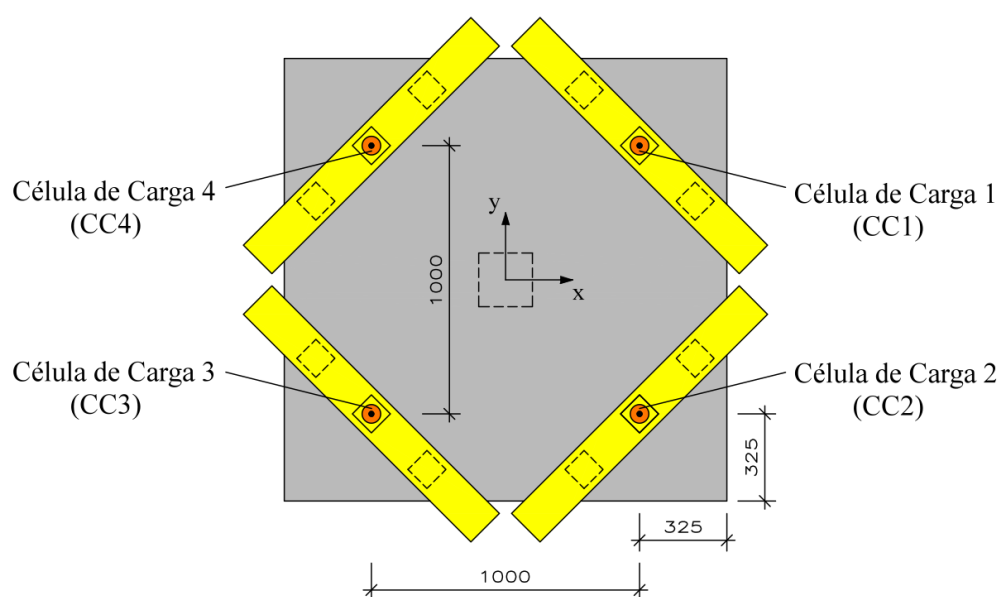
Disposição em planta das células de carga dos modelos (desenho sem escala e dimensões em mm).
